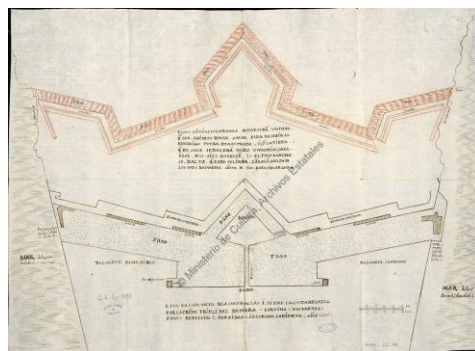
Planta del sistema defensivo de Puertas de Tierra. 1656. (Archivo General de Simancas MPD,62,073)
